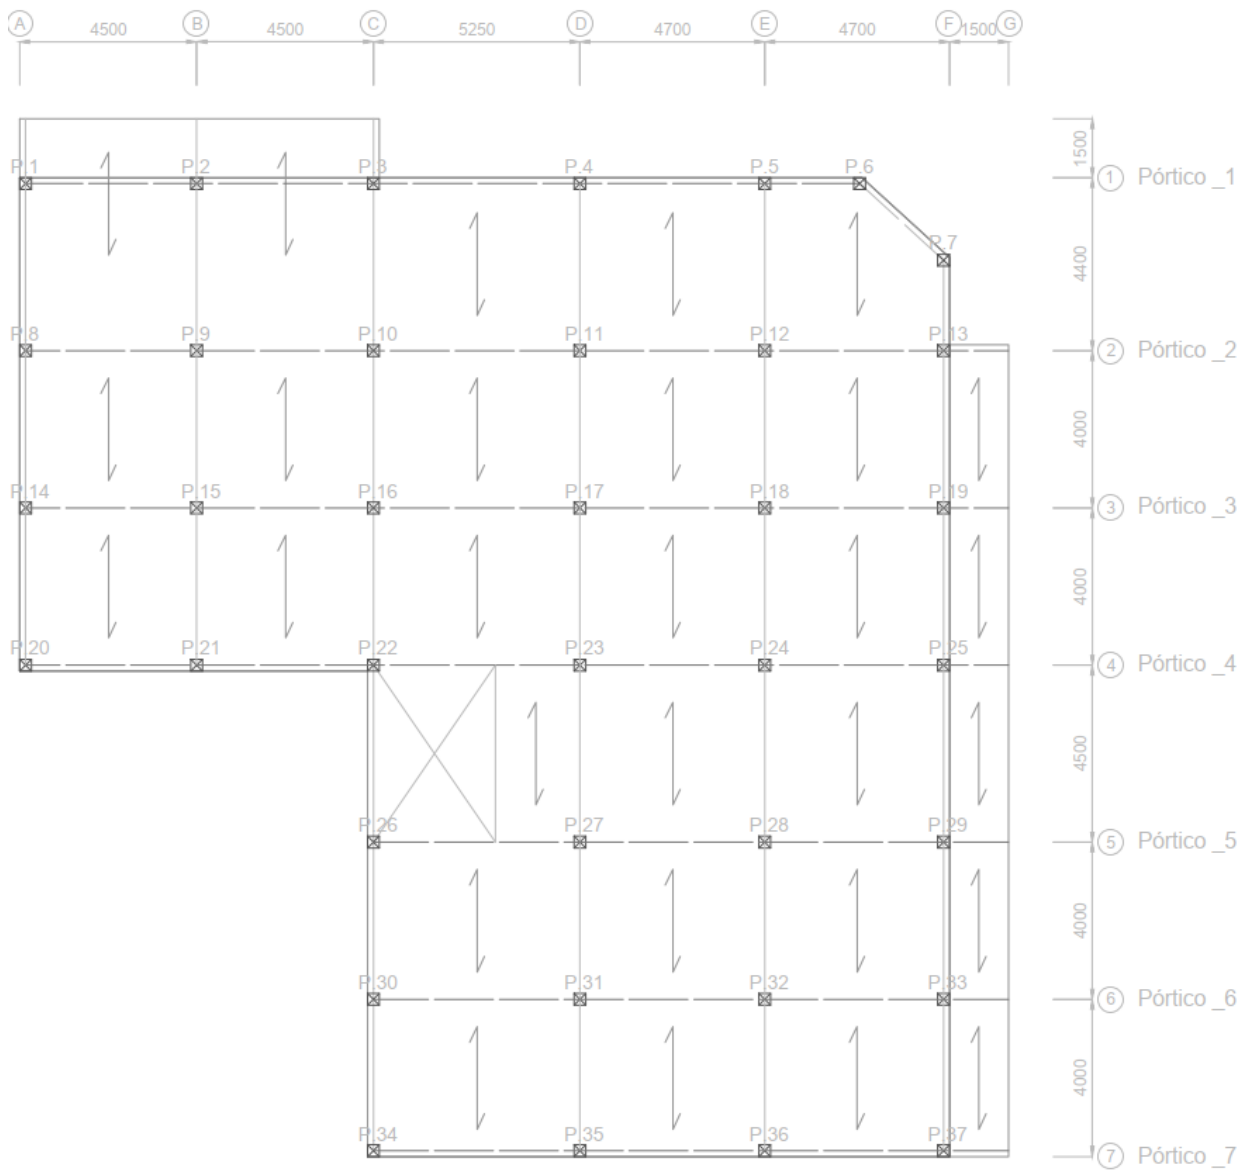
Planta estructural del edificio tipo con estructura de hormigón armado realizada en AutoCAD.
